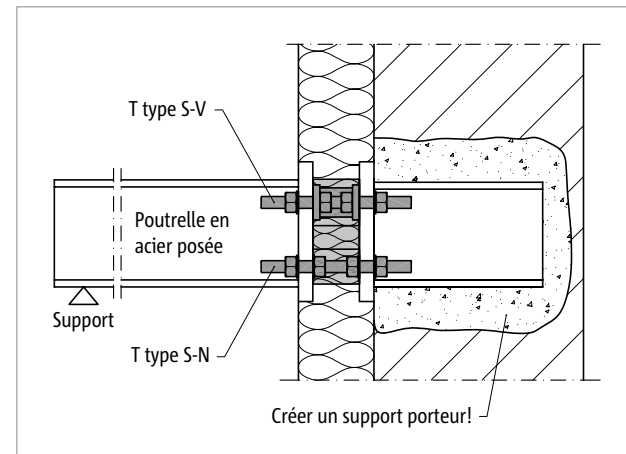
Schöck Isokorb® T type S-N et T type S-V : structure en acier supportée, montée ultérieurement, ; pour d'autres exemples de rénovation, cf. page 103
